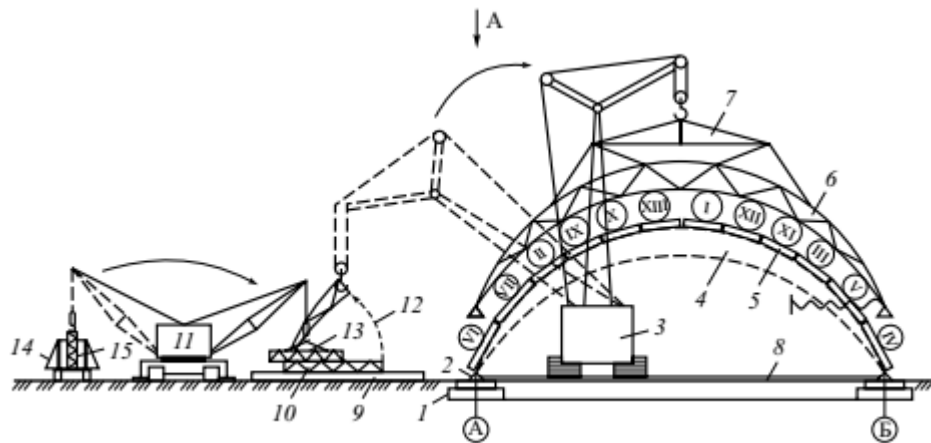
Технологічна схема монтажу двохшарнірних арок: 1 – фундамент арки; 2 – шарнірна опора; 3 – провідний монтажний кран; 4 – проектне становище арки; 5 – плити покриття; 6 – монтажне положення арки; 7 – монтажна траверса; 8 – бетонна підготовка (для переміщення монтажного крана по поздовжній осі будівлі); 9 – кондуктор-стенд для збирання арки; 10 – укрупнення арки з відправних марок; 11 – автокран, що обслуговує стенд; 12 – підйом арки у вертикальне положення на стенді; 13 – відправна марка арки; 14 – автопоїзд (причіп-розпуск) для транспорту відправних марок; 15 – відправний елемент на платформі причепа-розпуску; I–II–III...XIII – послідовність «заповнення» арного покриття плитами
